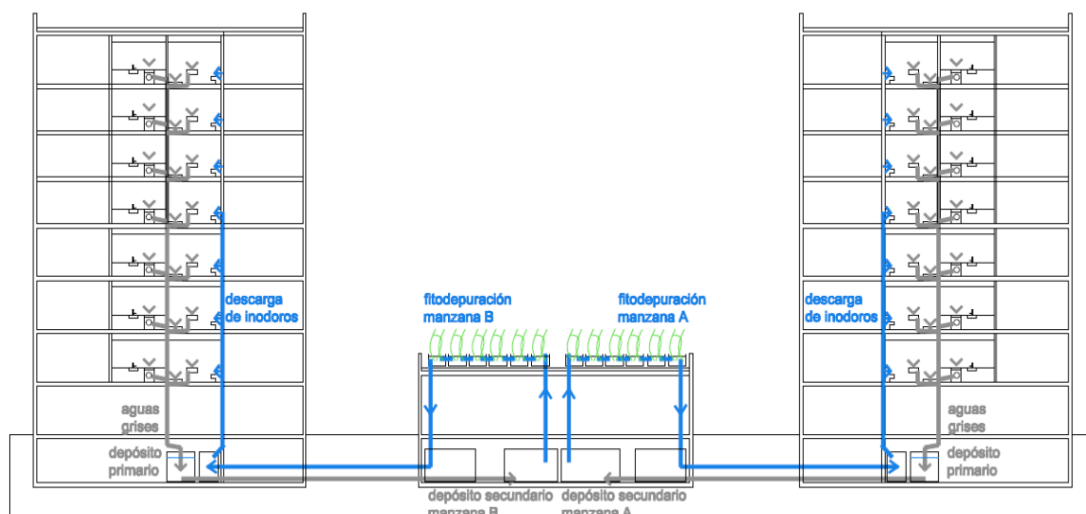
aplicación del sistema de fitodepuración en las cubiertas de las viviendas existentes
